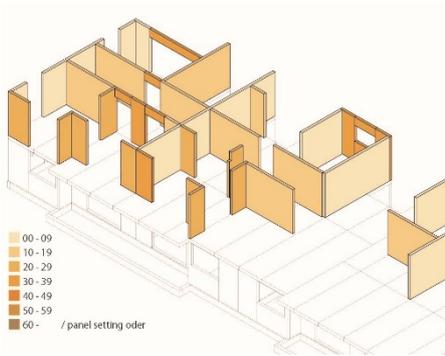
AW棟2階部分の壁パネルセット作業順序 AW 2nd floor wall panel setting order
